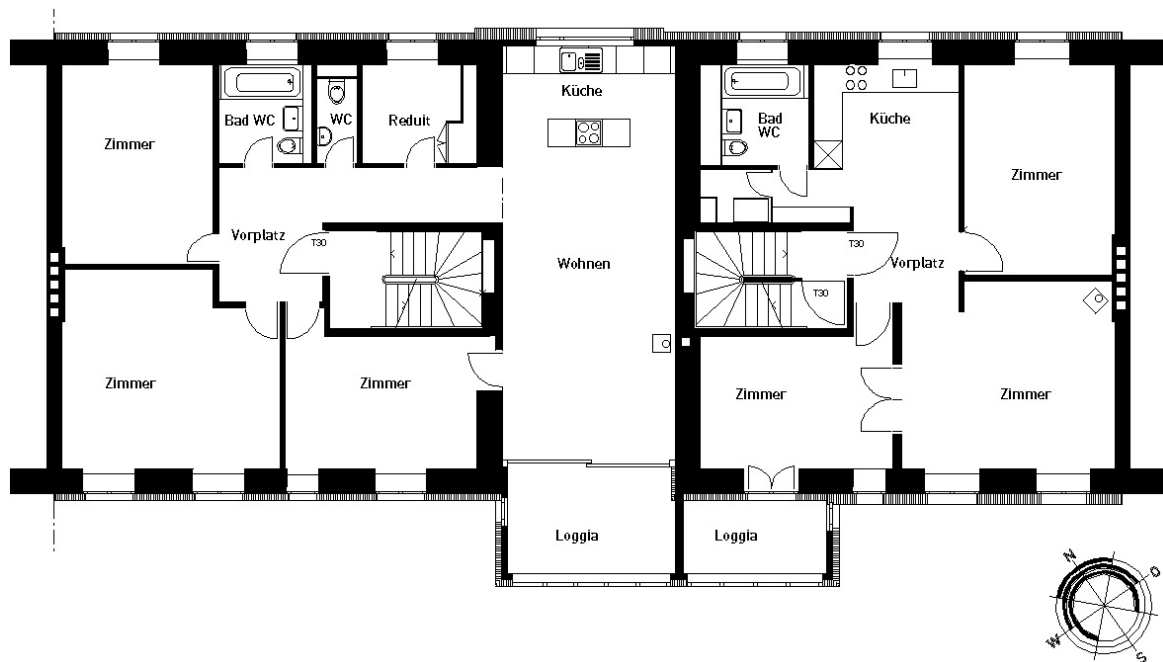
, Grundriss Normalgeschoss Haus 9 + 15
